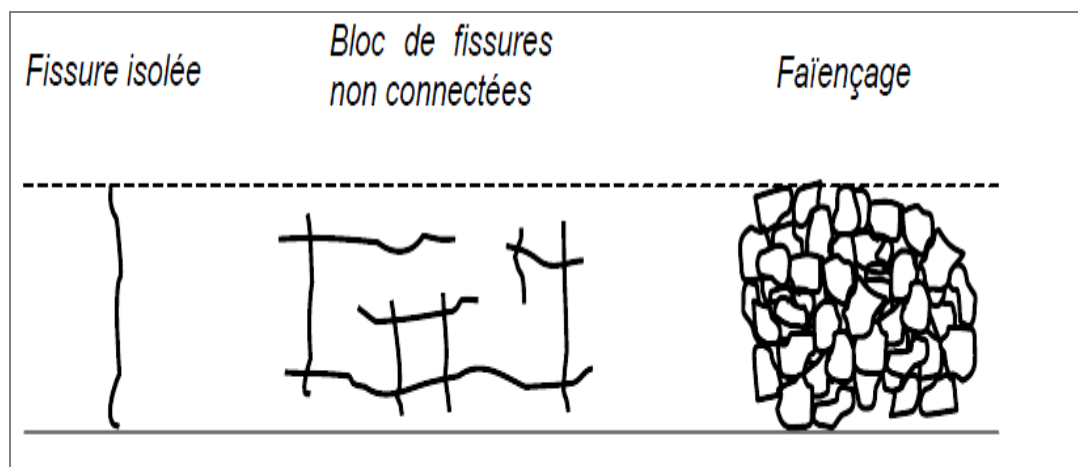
Différents chemins de fissuration (vue de haut de la chaussée) [37].
